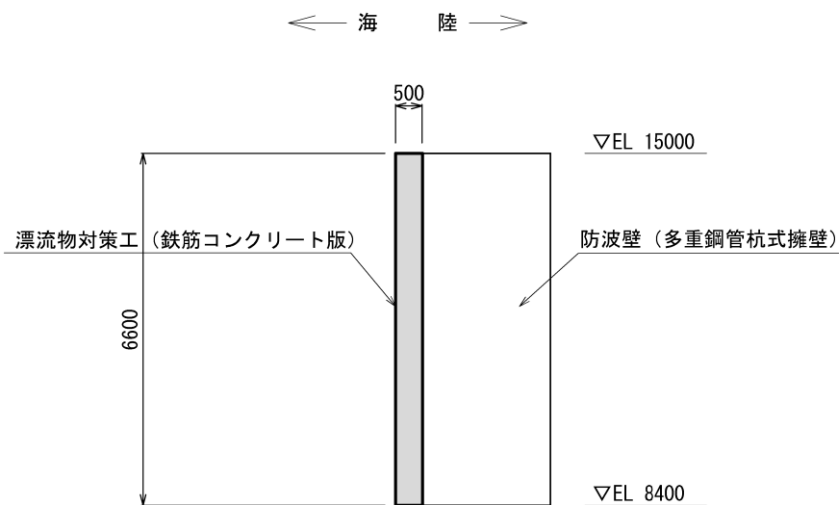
(3) 漂流物対策工（鉄筋コンクリート版）の構造概要図（標準断面図）
